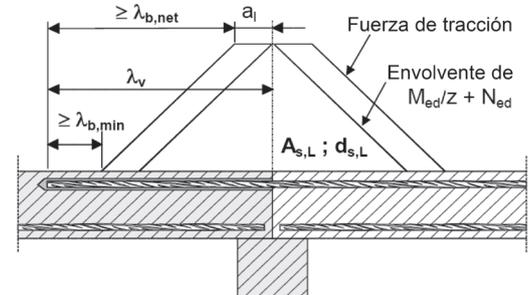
Anclaje de refuerzo para cubrir la línea de actuación de la fuerza de tracción.
